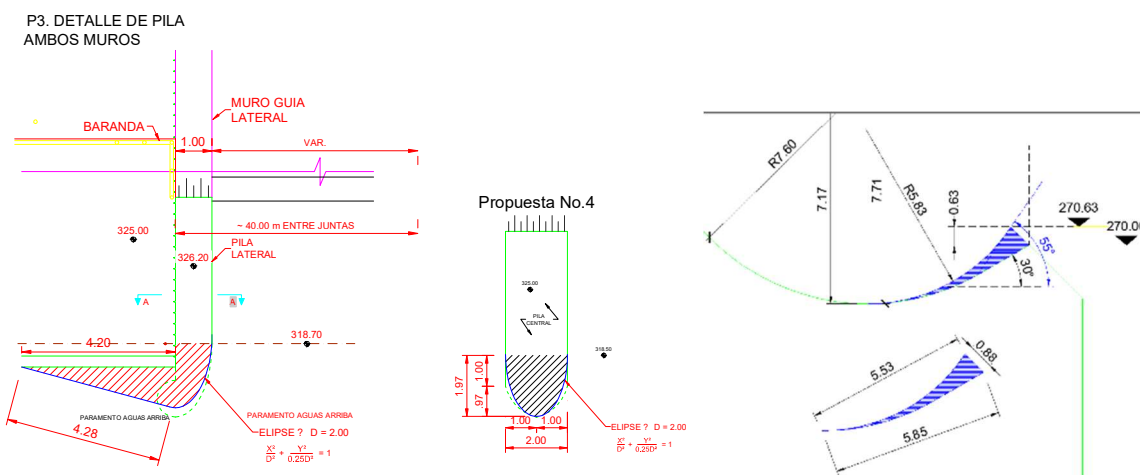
Vista en planta de la geometría de modificación de pilas laterales y centrales, y modificación del labio del deflector central propuestas para la serie 7.
